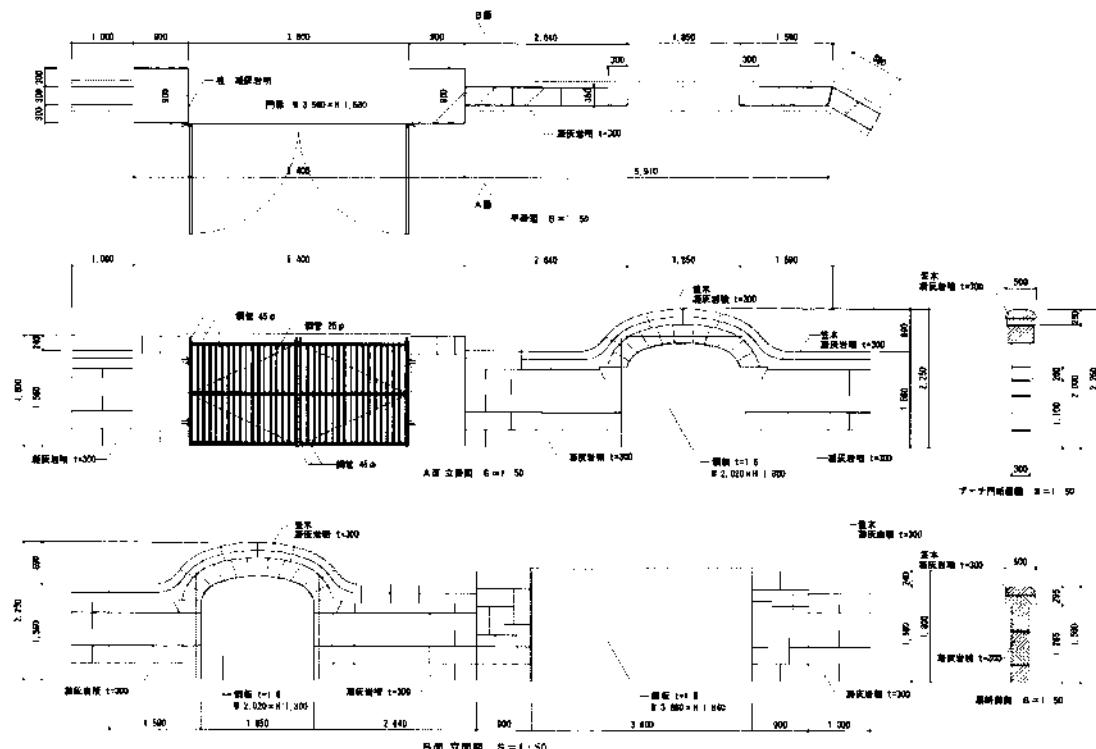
石造裏門 立面図・平面図 (株式会社シン技術コンサル提供)
